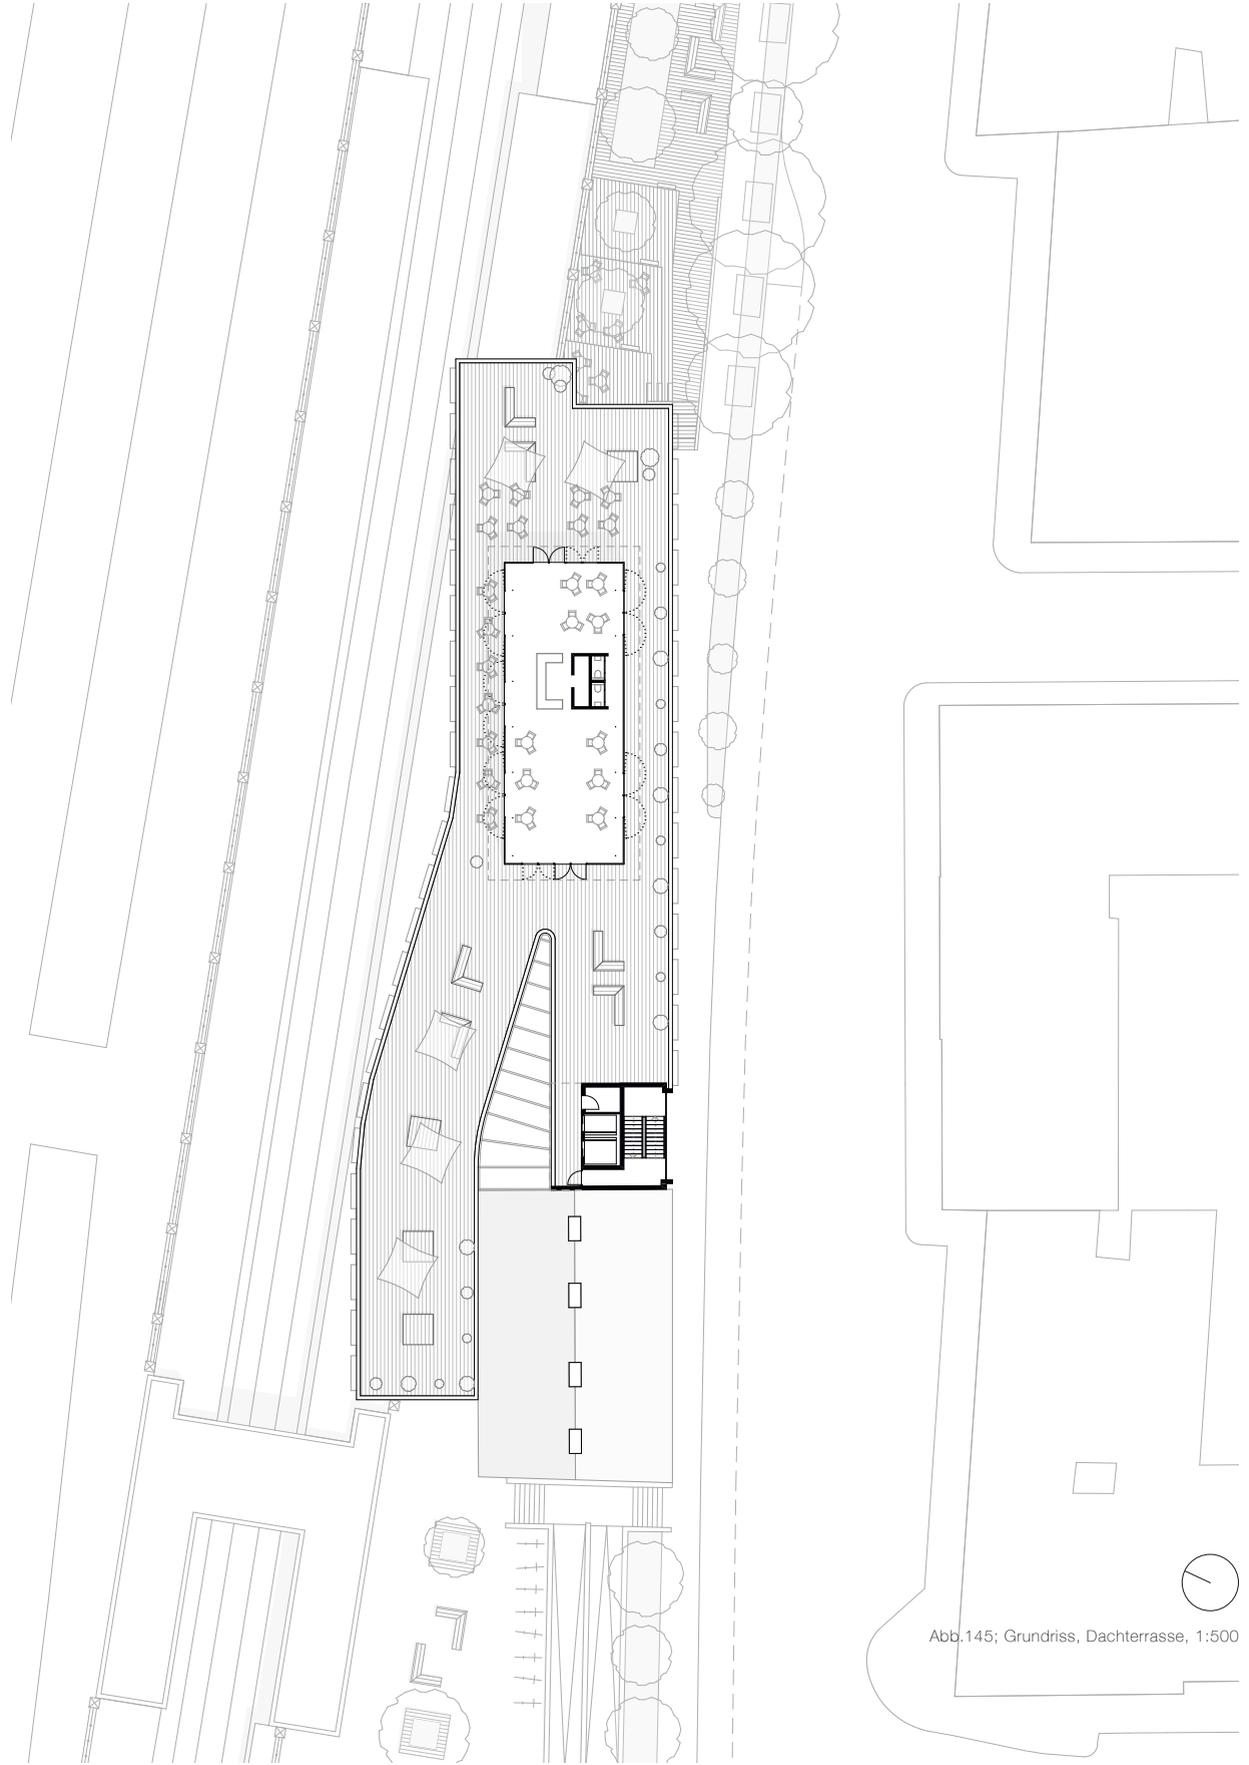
; Grundriss, Dachterrasse, 1:500
